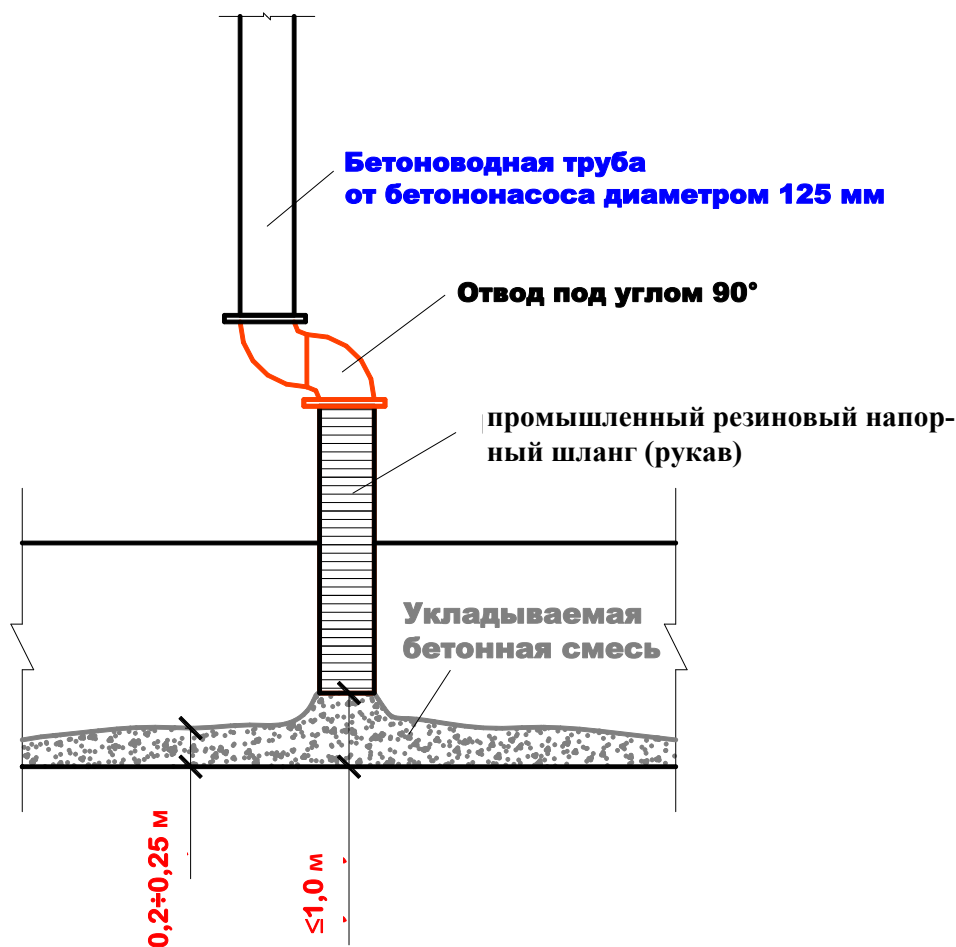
Схема укладки слоев бетона при бетонировании ярусов купольной части внутренней защитной оболочки
